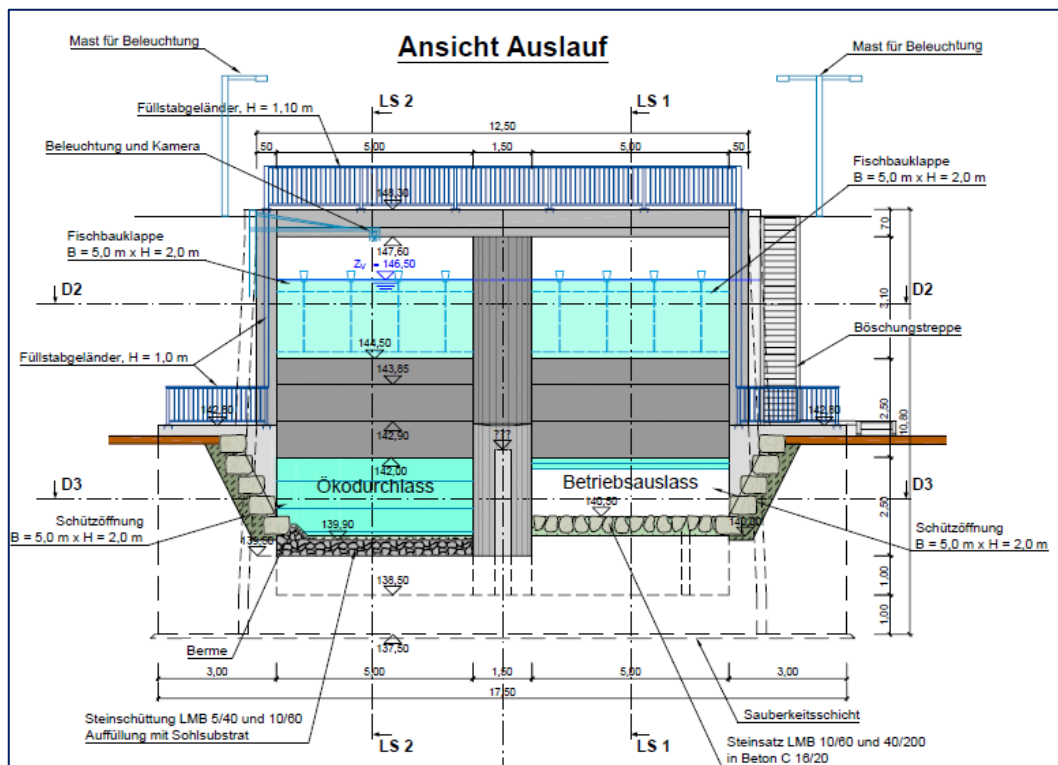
Ansicht Auslauf des HRB mit Ökodurchlass, Betriebsauslass sowie zwei der Hochwasserentlastung dienenden Fischbauchklappen. Zeichnung WALD + CORBE (2022).
